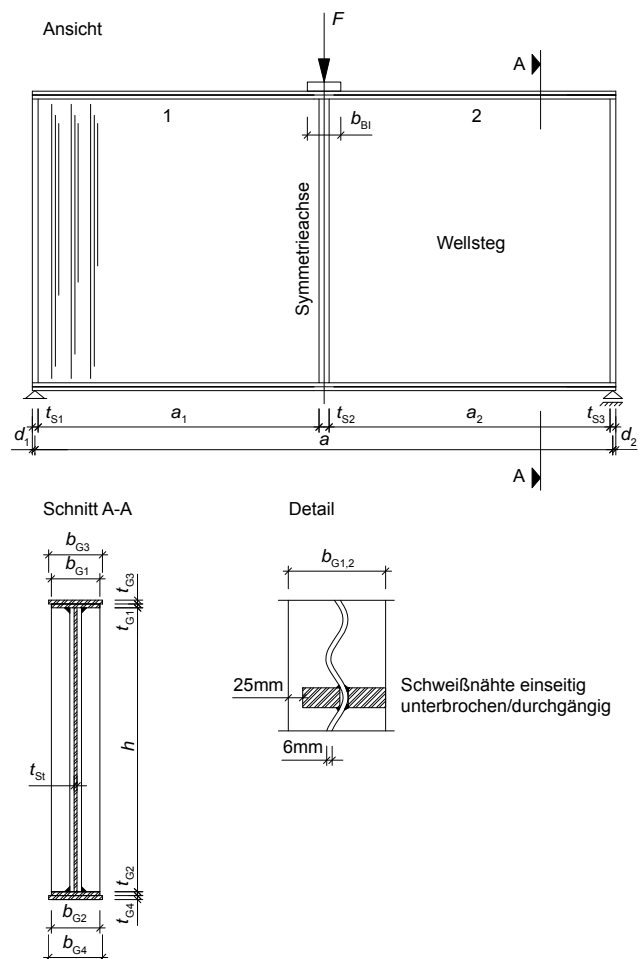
Schweißen von Wellstegträgern
